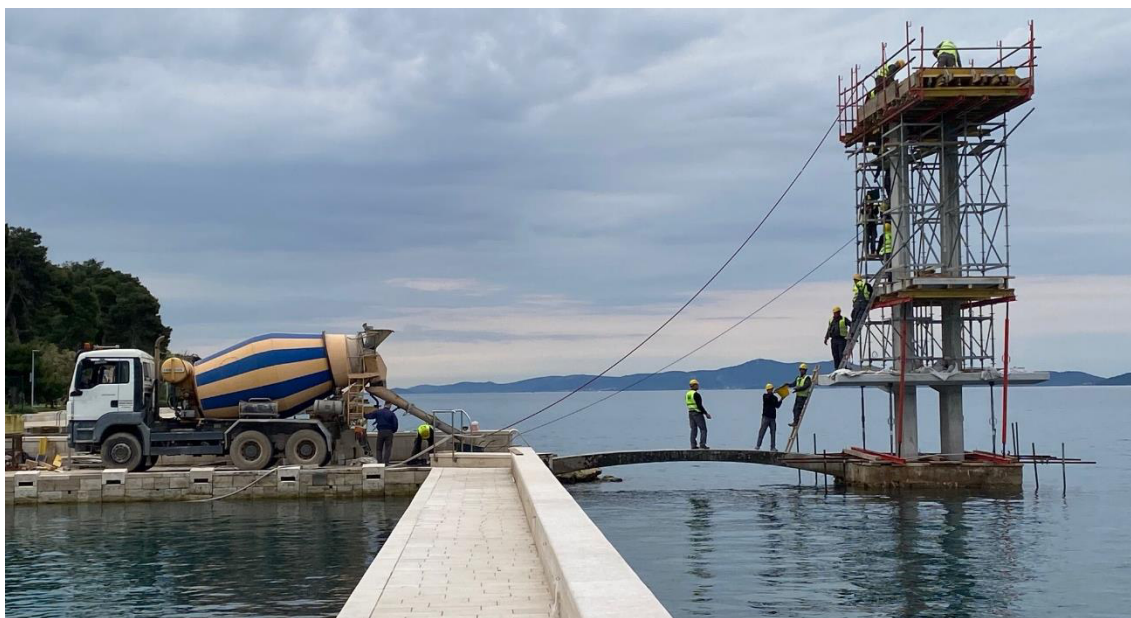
Radovi na armiranju stupišta i ploča podesta te uklanjanje oštećenog betona oko temelja
